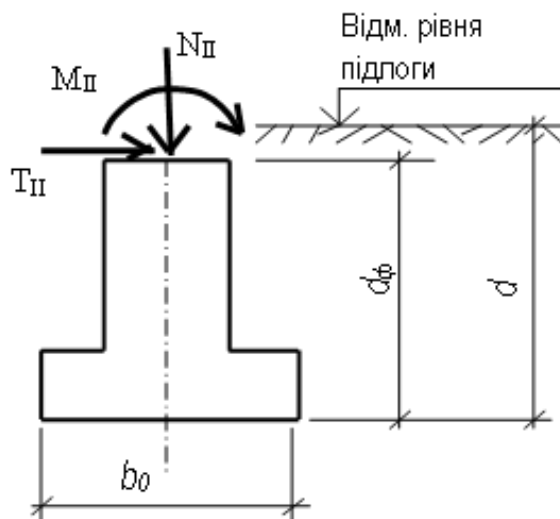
Попередня розрахункова схема фундаменту на природній основі
